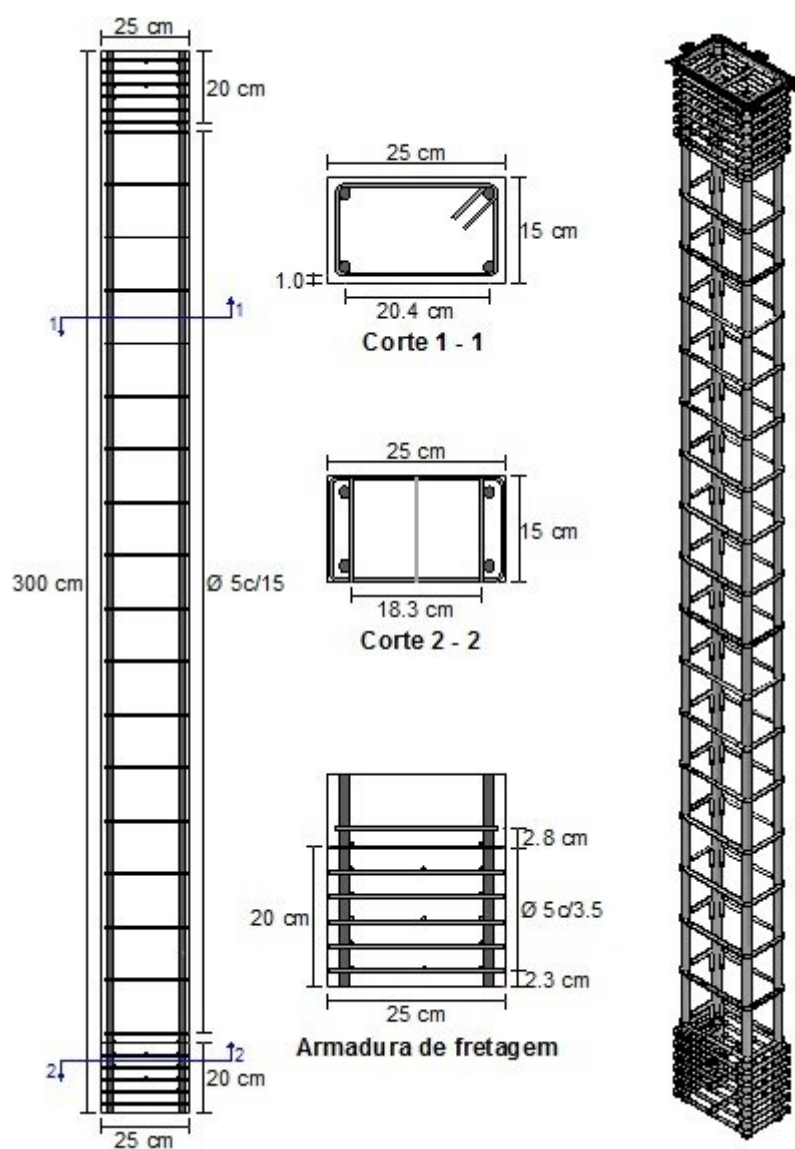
Detalhamento das armaduras dos pilares C40-2.1 e C80-2.1
